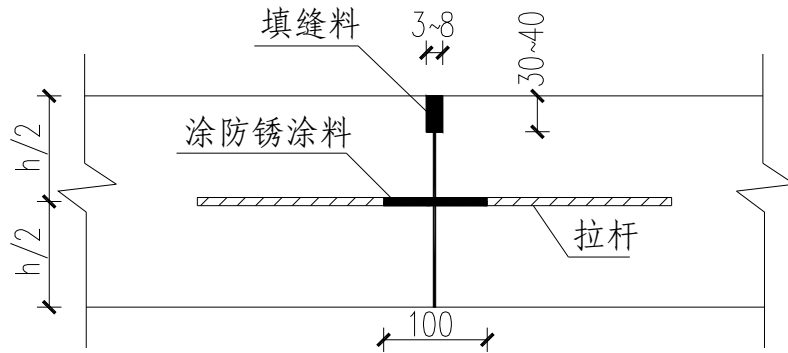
纵向施工缝构造 (尺寸单位: mm)
